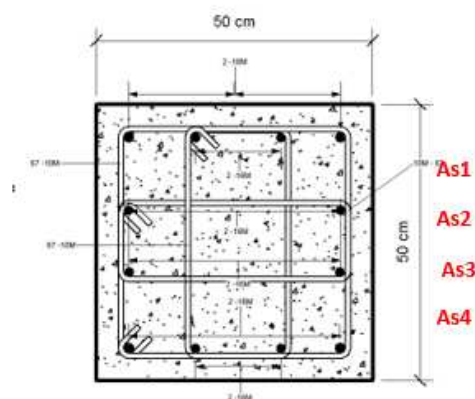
Armado de refuerzo de la columna (SMF) del sistema de 6 Pisos
